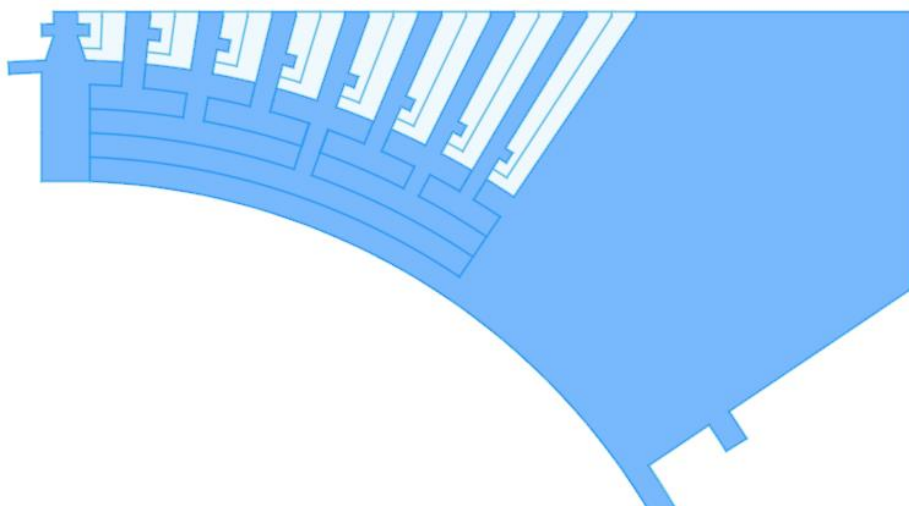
| Elaboración propia | Ilustración 95 Ilustrada en un plano. Las piezas marcadas en azul forman la estructura interior a partir de la técnica binary approach
